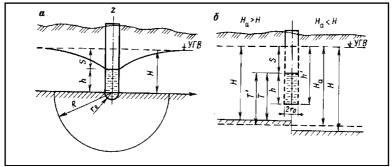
Схема к расчету колодца при очистке грунтов и грунтовых вод: а - совершенный колодец; б - несовершенный колодец
